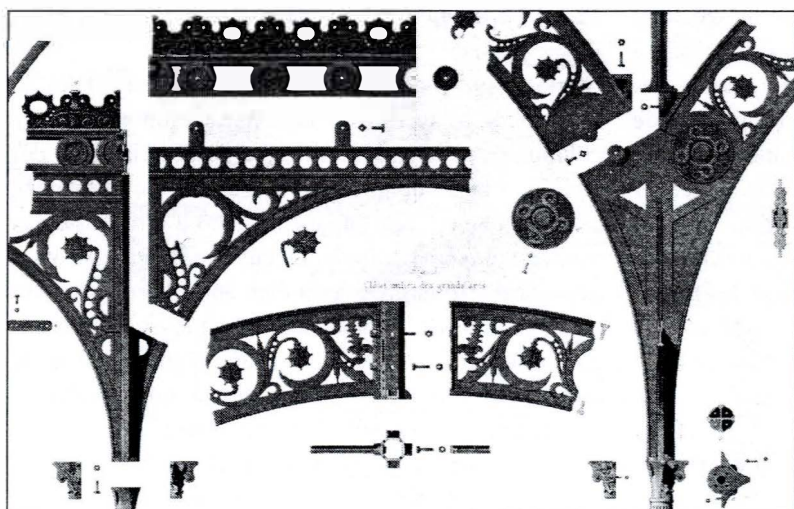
Detalles de las armaduras de la Biblioteca de Santa Genoveva
